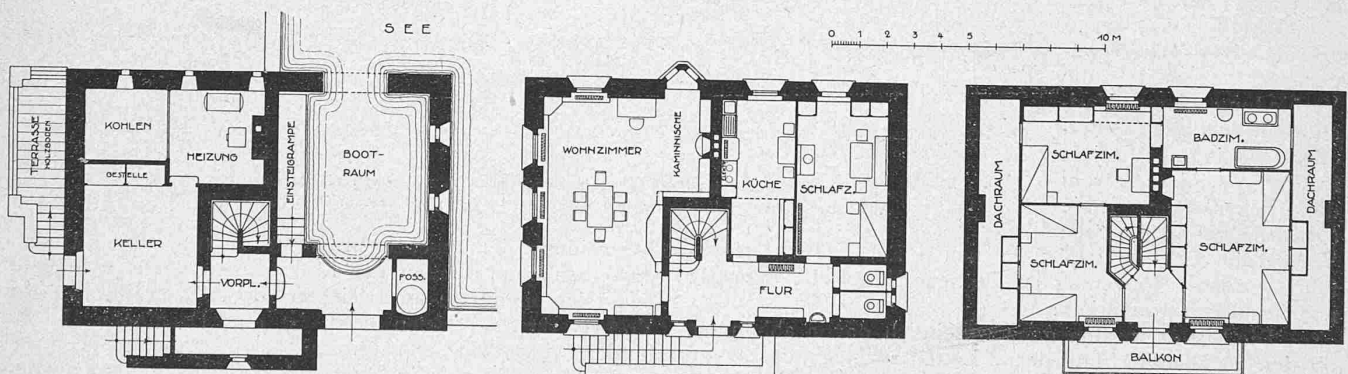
bis 7. Ferienhaus Bartuns. — Architekten Rittmeyer & Furrer, Winterthur. — Grundrisse, Masstab 1:250.
